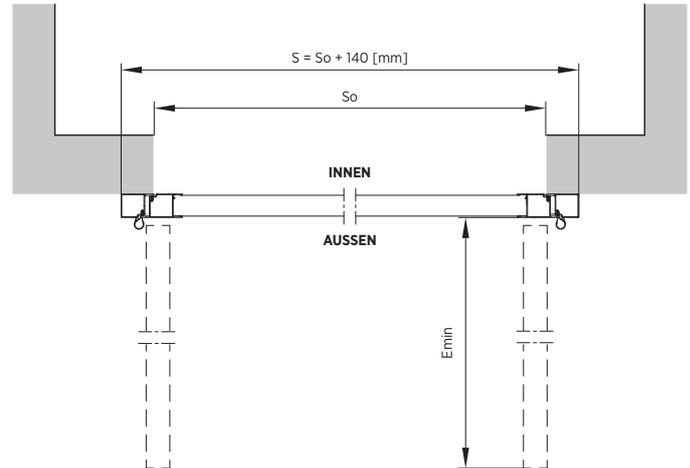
Montage vor der Öffnung – horizontaler Schnitt – zweiflügeliges Drehflügelort Presto 50
